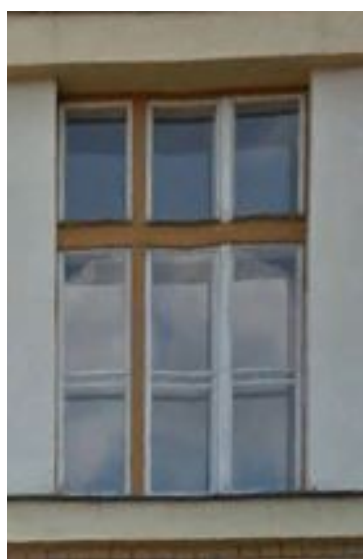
FOTO STAVAJÍCÍ STAV - EXTERIÉR
